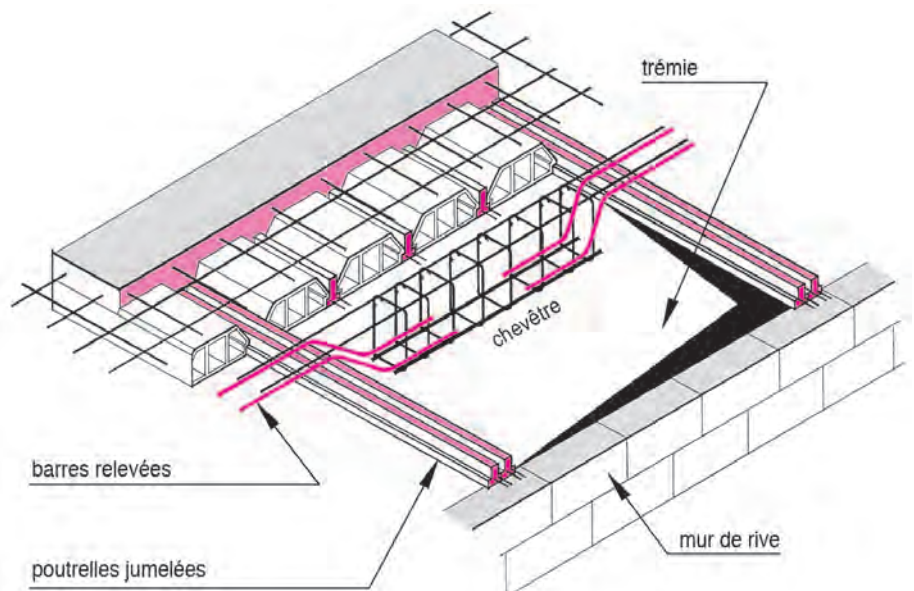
Chevêtre porteur des poutrelles dans le cas d'une trémie
